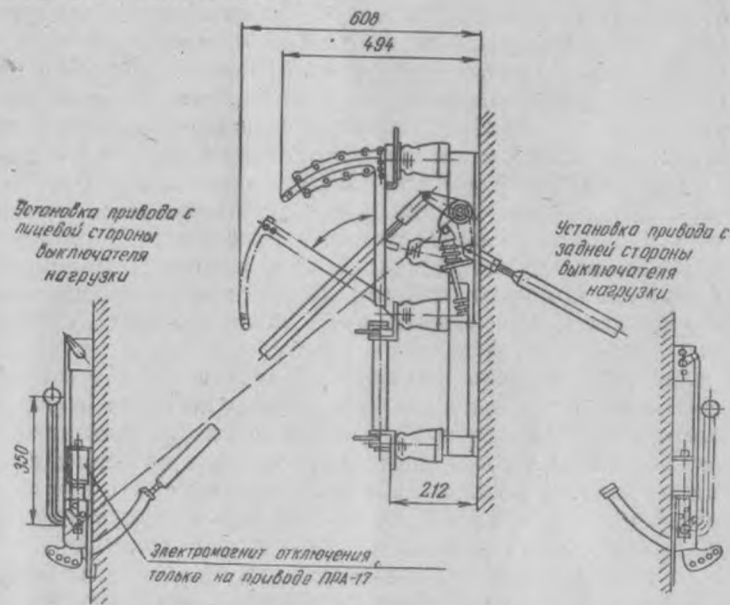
Установка выключателя нагрузки с приводом ПР-17
